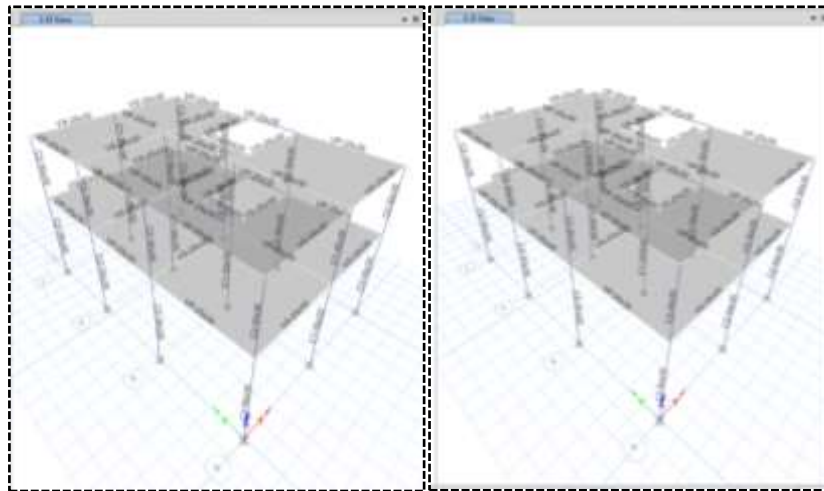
Diseño estructural, dimensión de la viga y columna de una vivienda unifamiliar utilizando concreto patrón y concreto con adición del 1%CHH.
